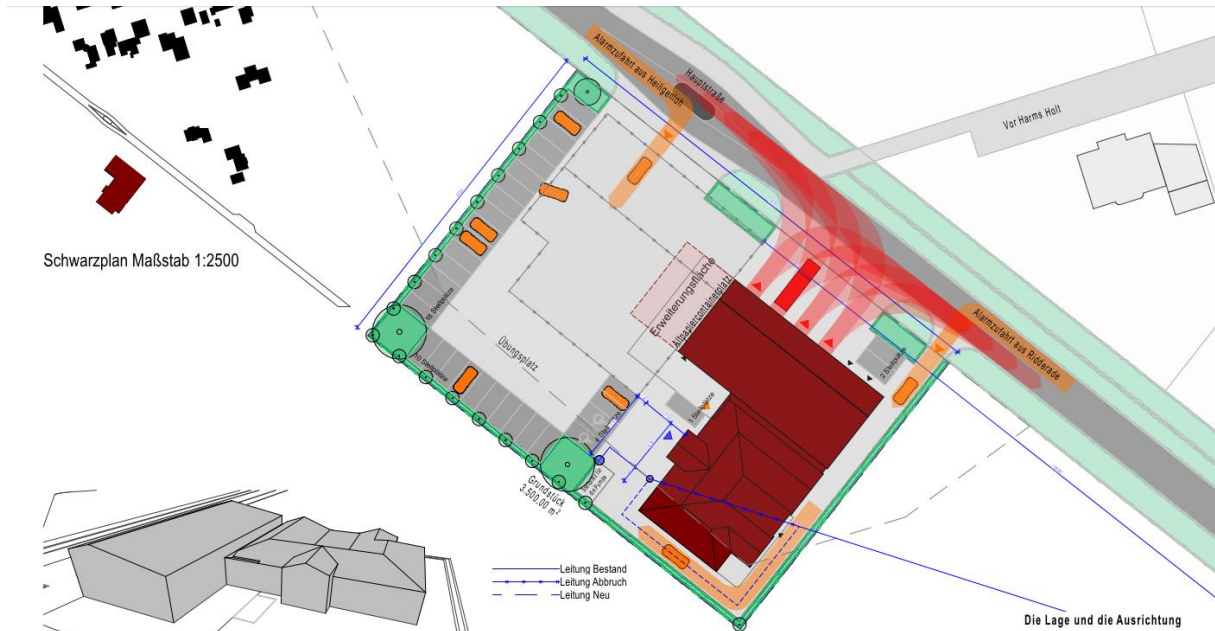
Lageplan der geplanten Freiwilligen Feuerwehr
